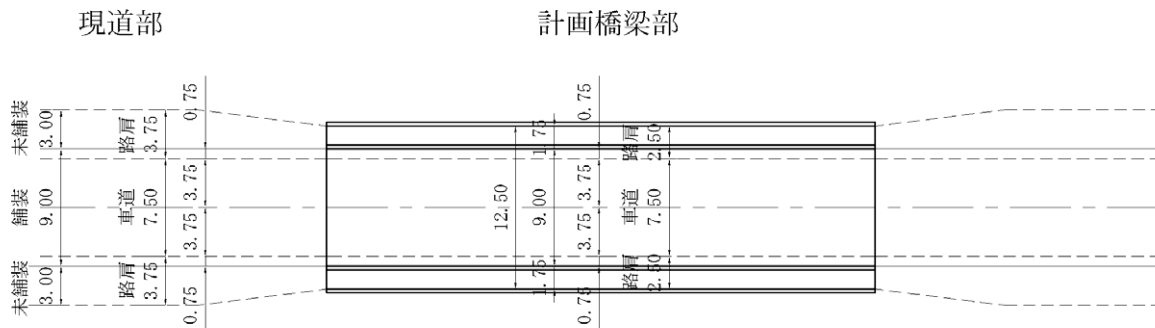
アラムジン橋（橋梁番号 No. 1）平面図
